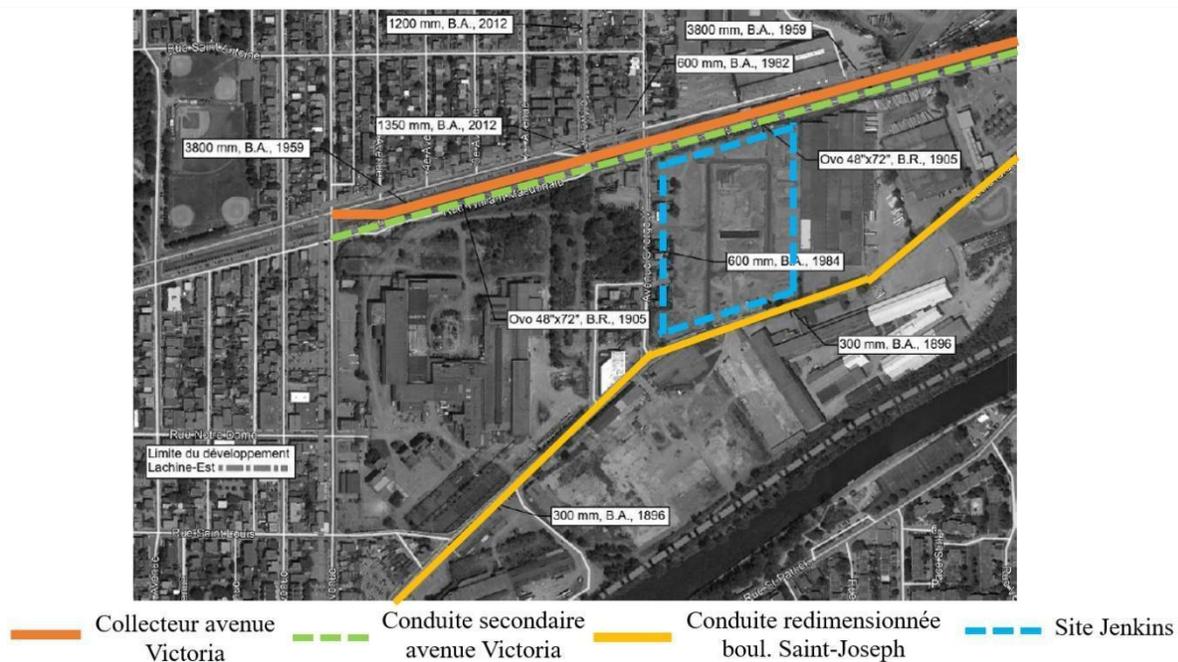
Conduites principales du réseau unitaire existant et emplacement du site Jenkins
